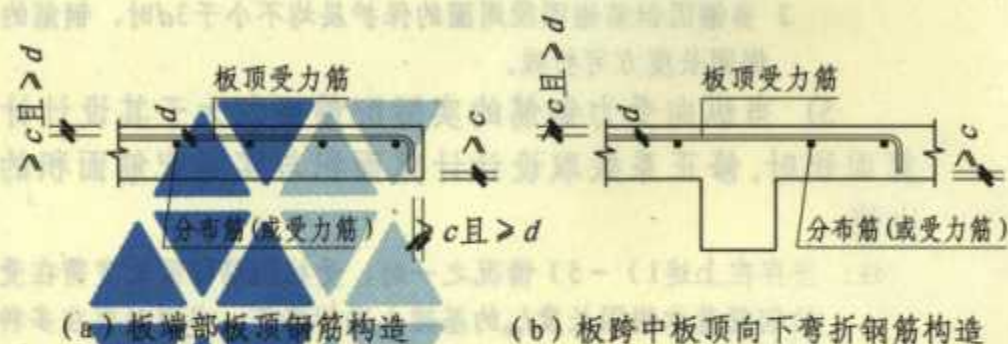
板钢筋的混凝土保护层厚度示意图（二）
